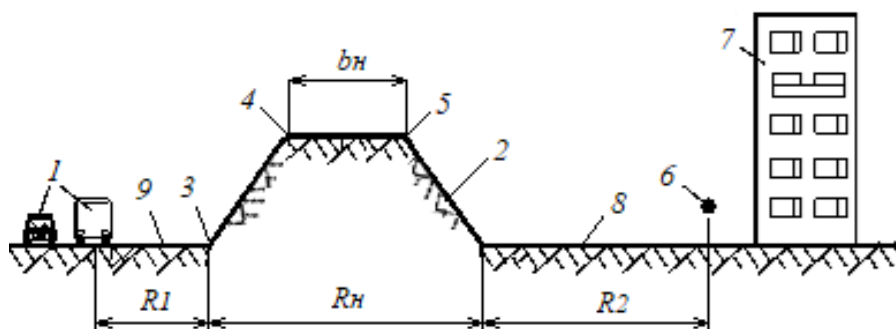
Расчетная схема прохождения звука за насыпь: 1 – источник шума (ИШ); 2 – насыпь; 3 – основание насыпи; 4 – левая кромка насыпи; 5 – правая кромка насыпи; 6 – расчетная точка (РТ); 7 – защищаемое здание; 8 – опорная поверхность; 9 – часть опорной поверхности между ИШ и насыпью
